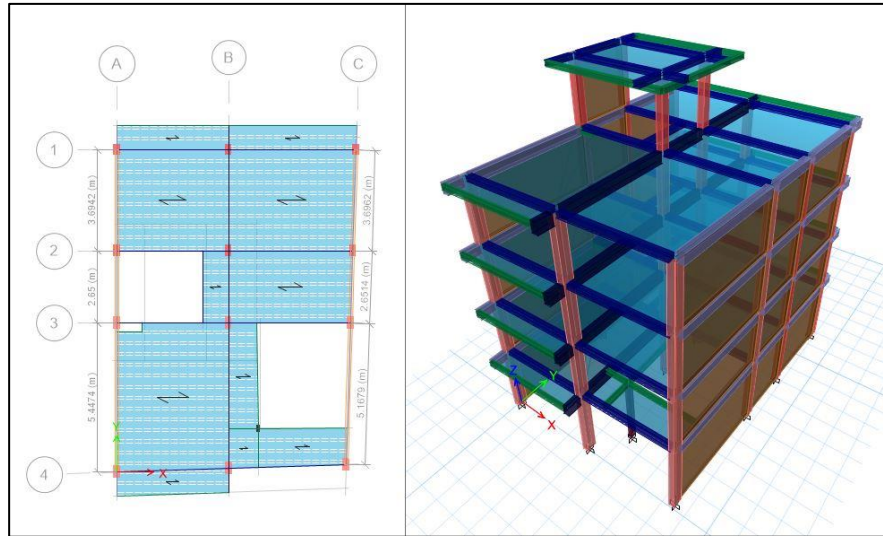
Vivienda Informal de 4 Pisos (ET-5), Vista en Planta (Izquierda) y Vista 3D (Derecha)
